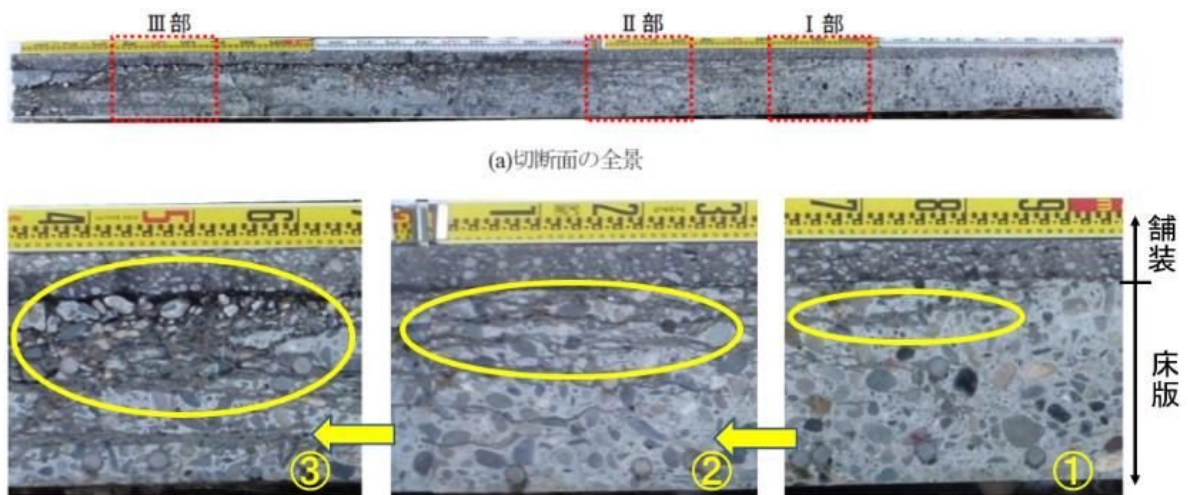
凍害を受けた床版の劣化の進行状況
